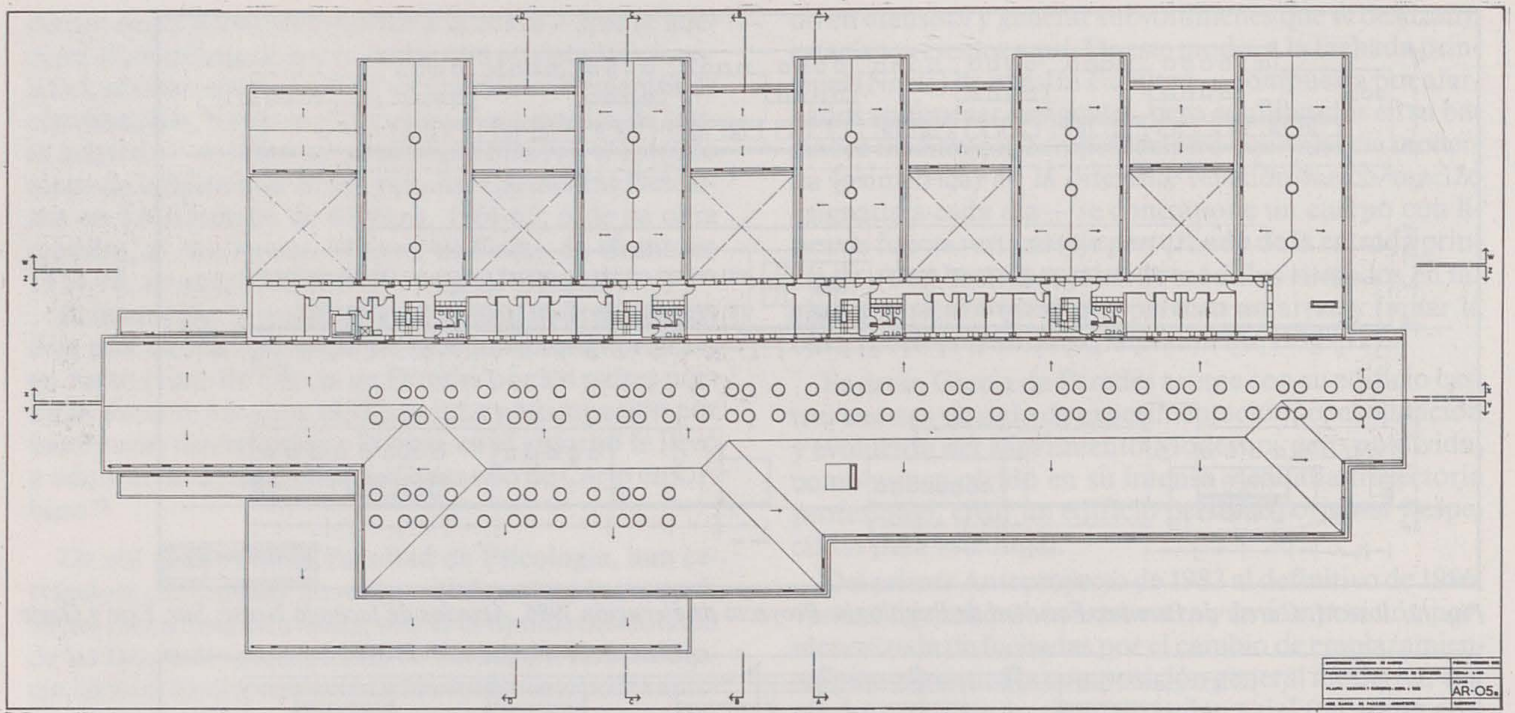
José M. García de Paredes: Facultad de Psicología. Proyecto de ejecución. Planta segunda.
